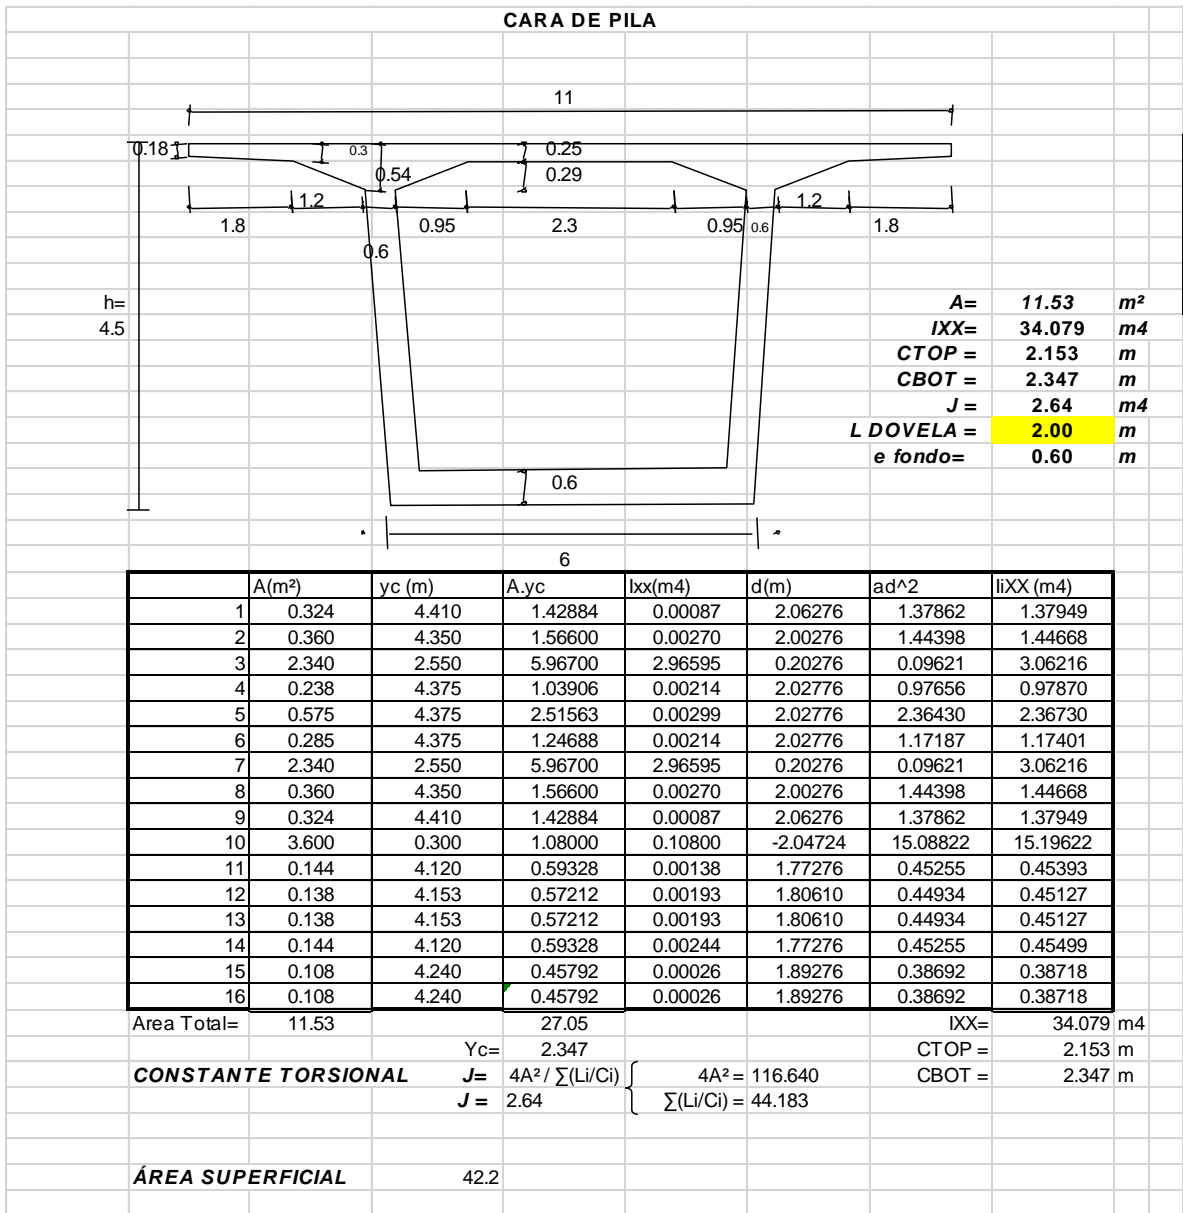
Geometría dovela cara de pila - Puente San Pedro
